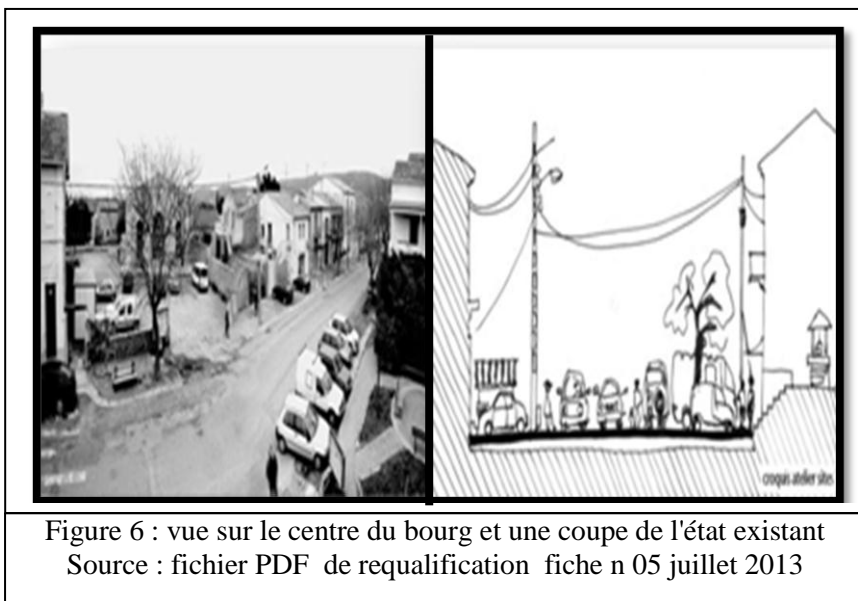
vue sur le centre du bourg et une coupe de l'état existant
